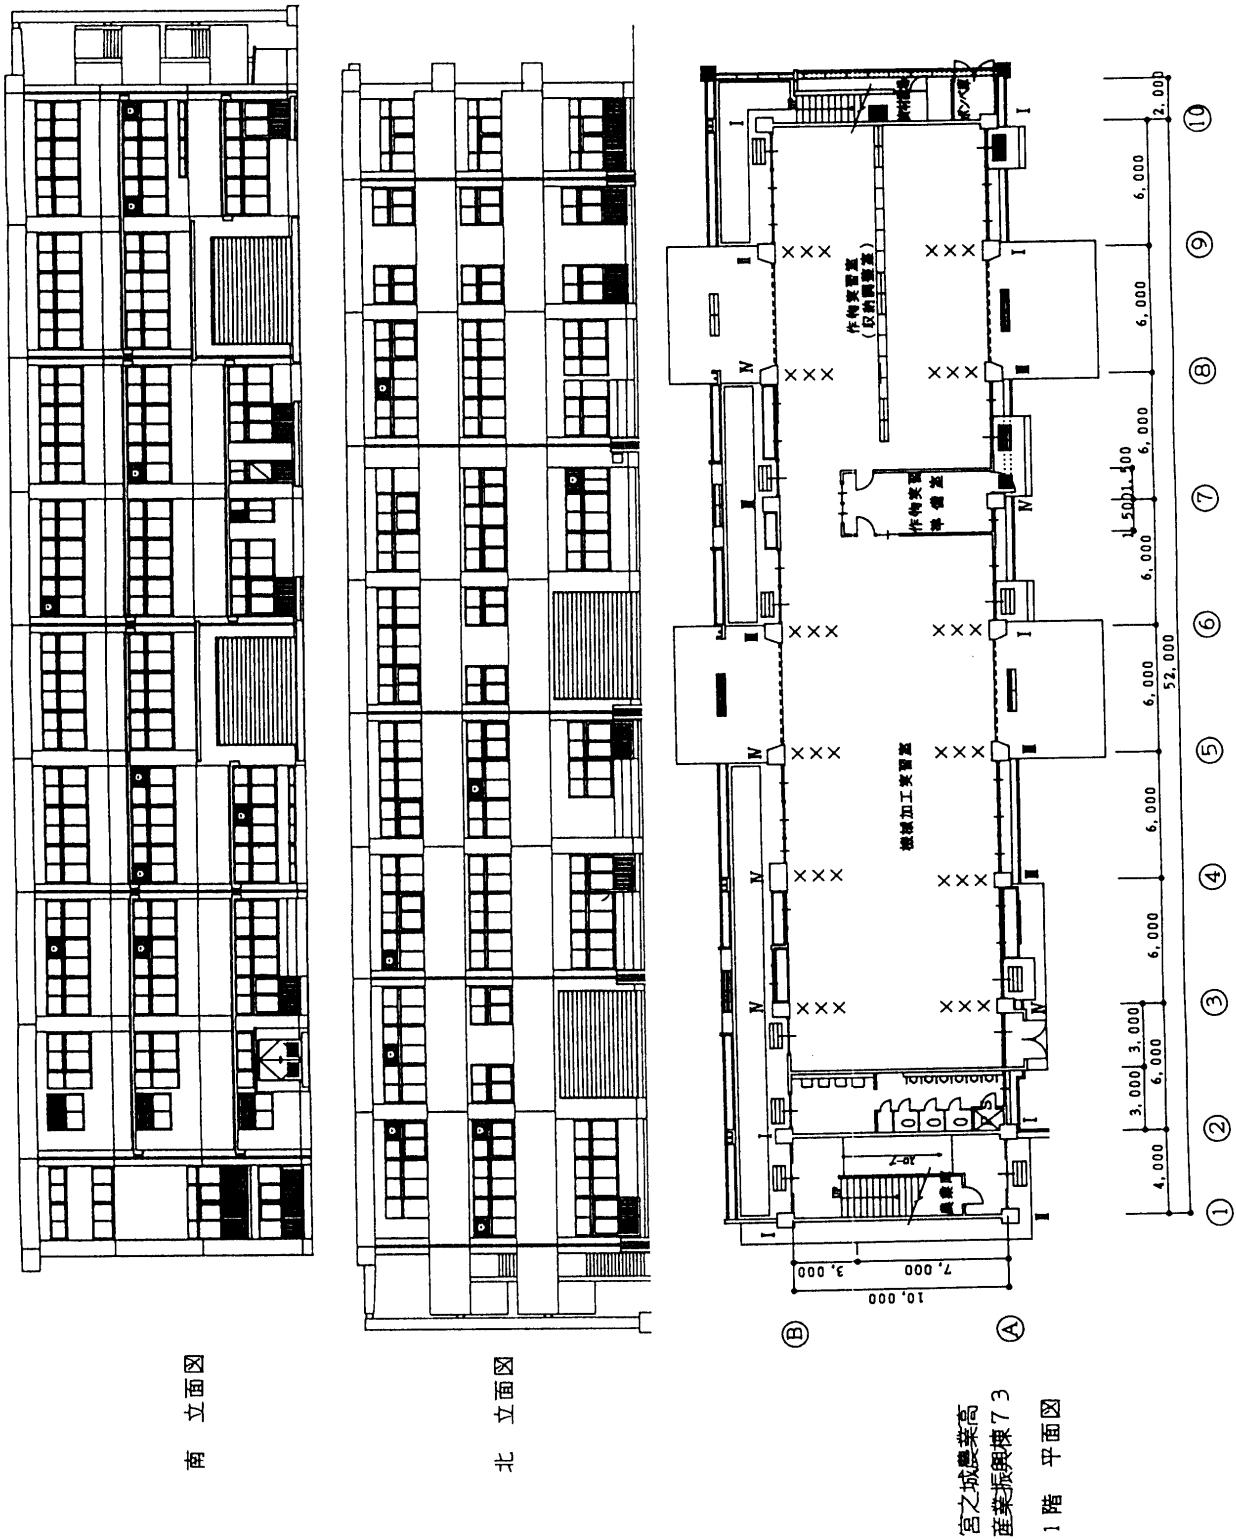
産業振興棟(73) 一階平面図および南北立面図
